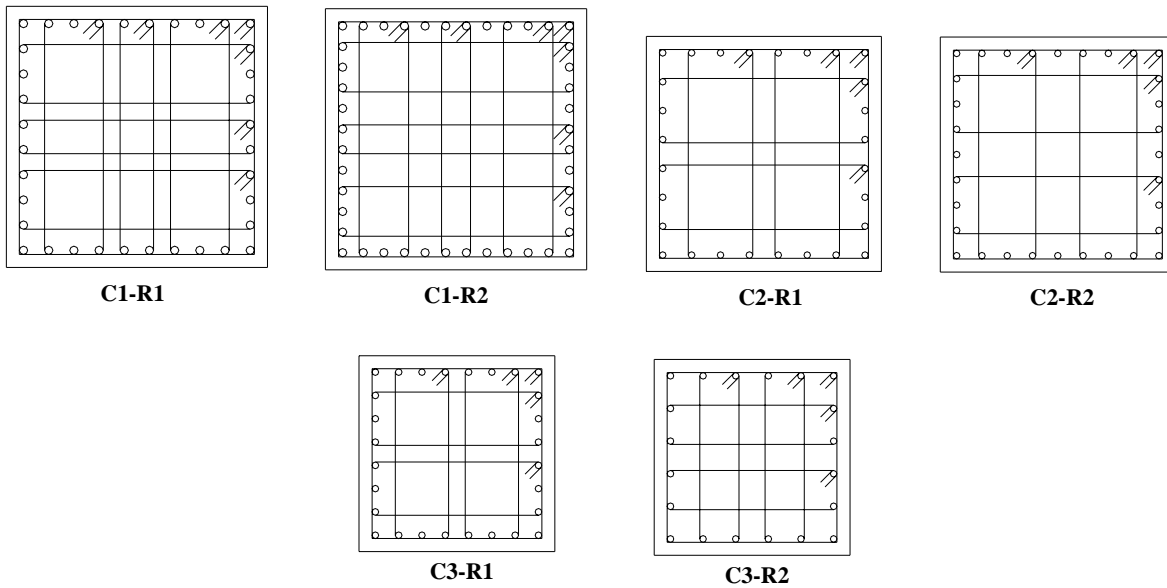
Secciones y refuerzos de las columnas del modelo M2Q3AA
